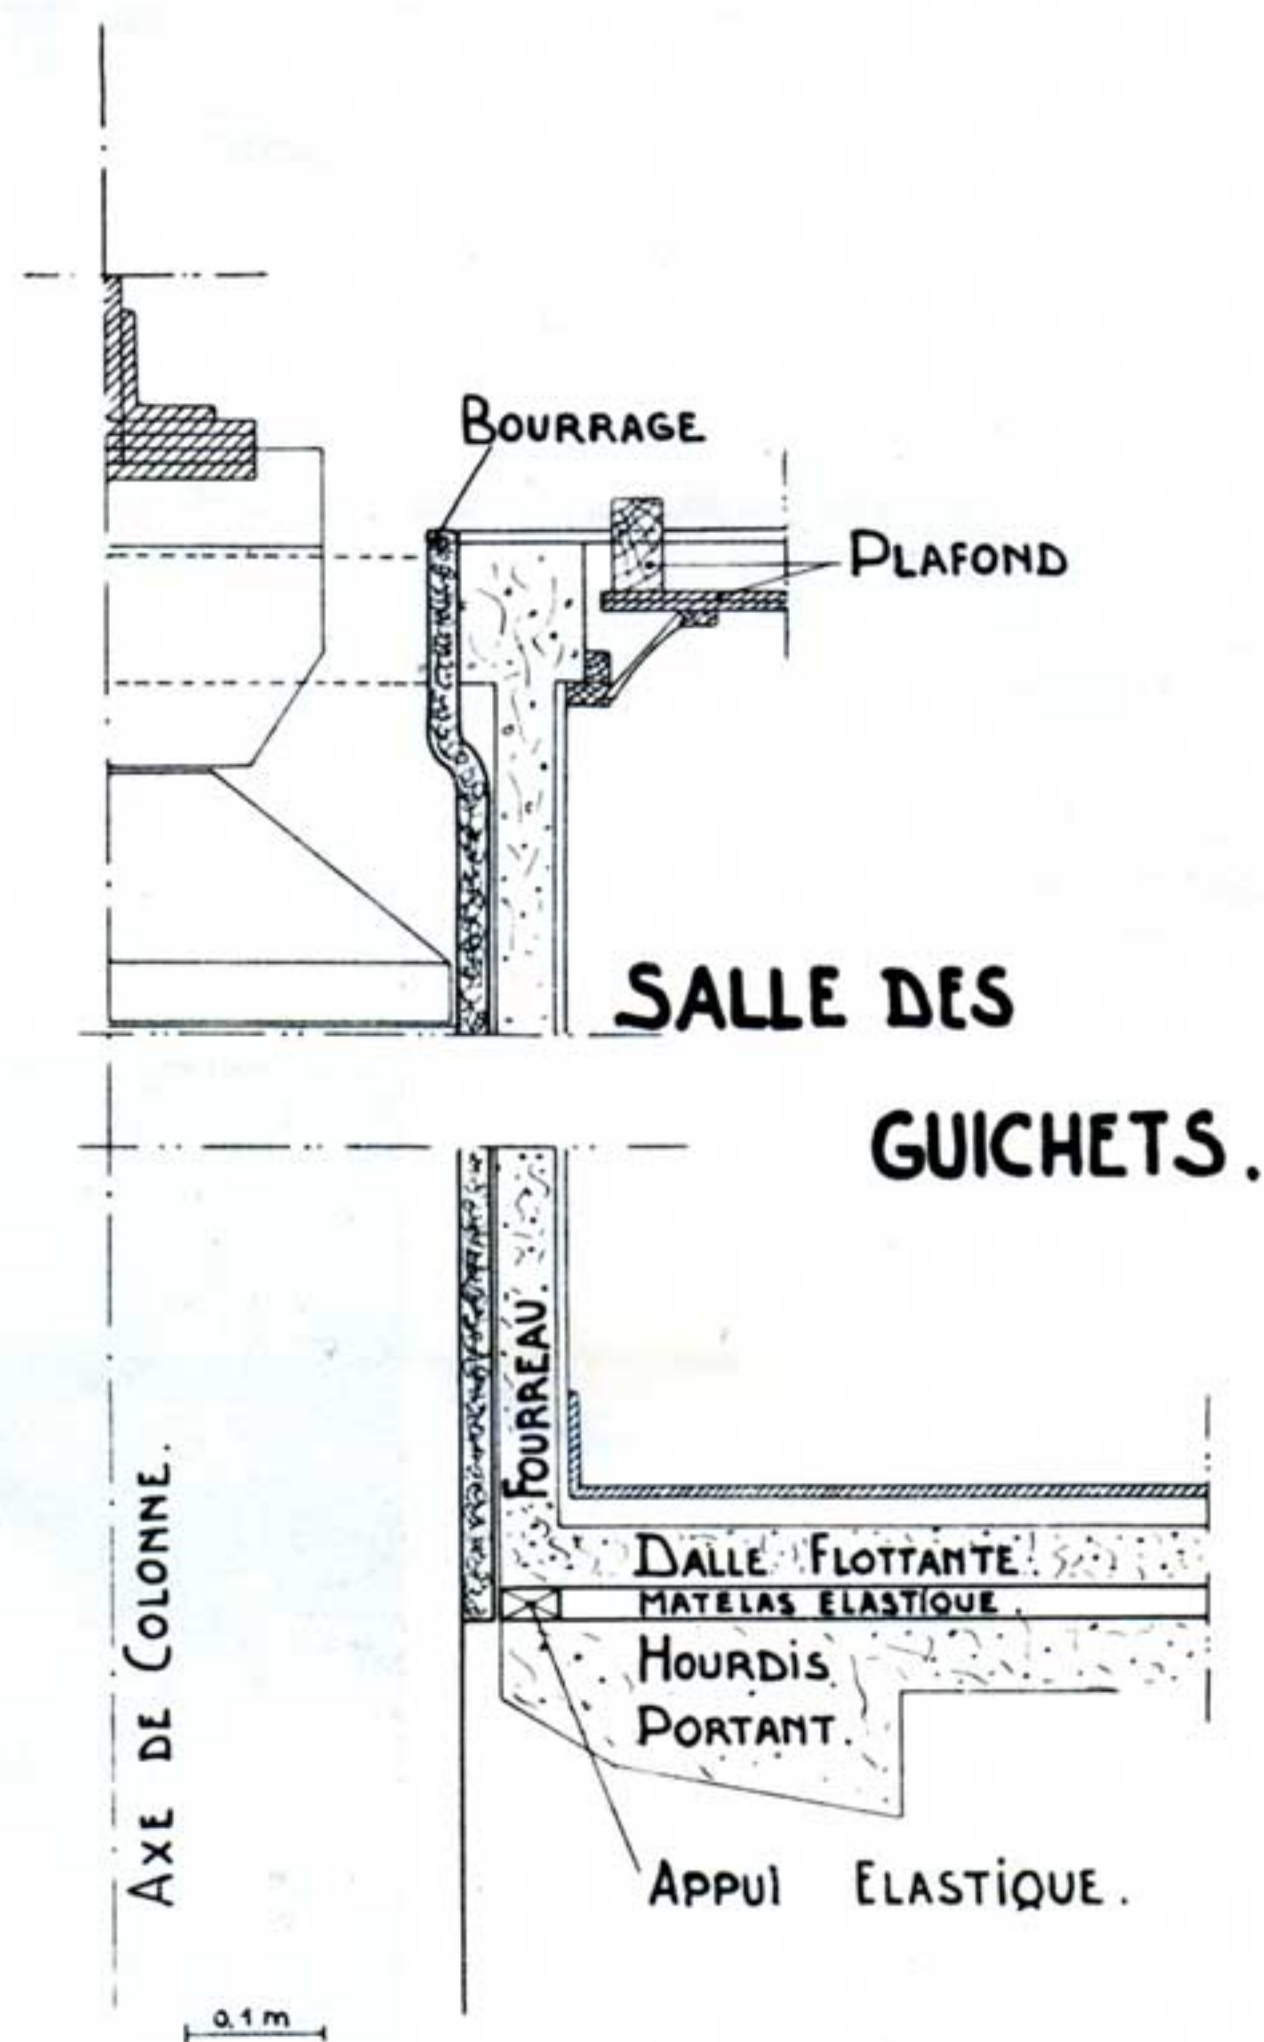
Coupe verticale d'un fourreau d'une colonne de la salle des guichets.
